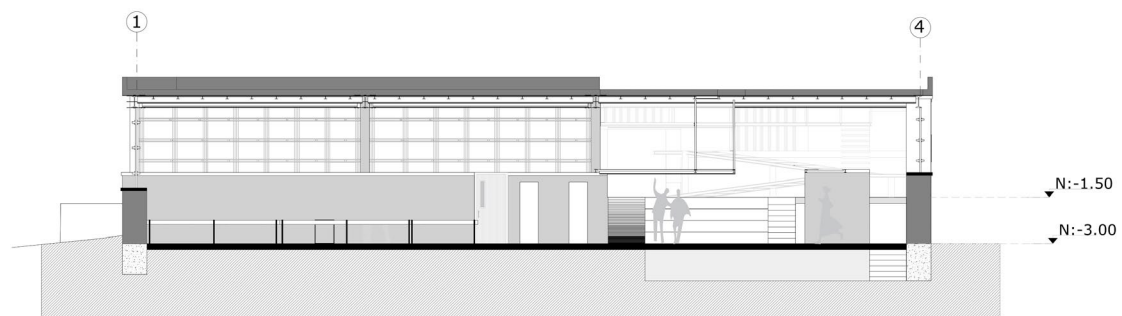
Corte DD' Bloque 1. Elaboración: (Pérez, 2018)
